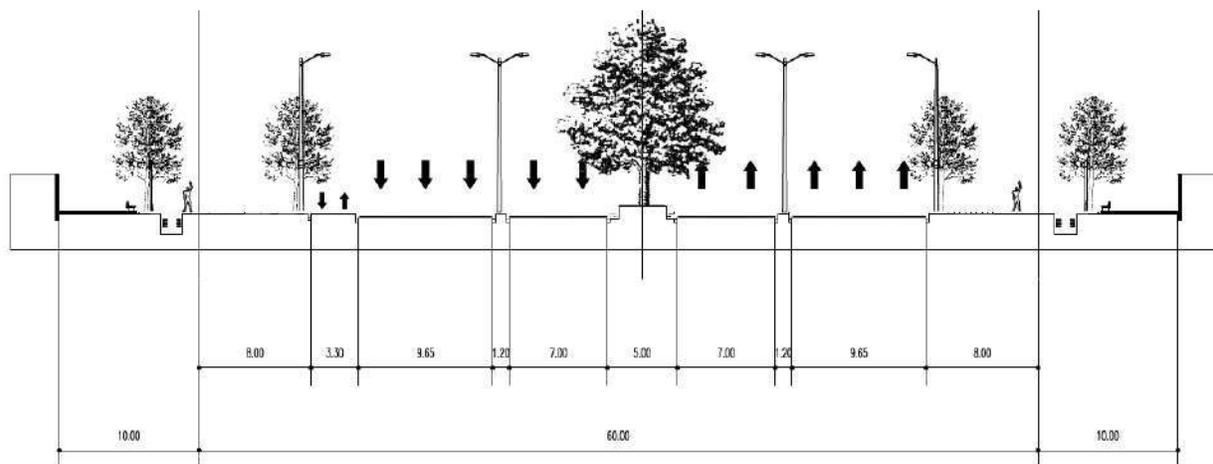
Perfil vial Avenida Medellín (Calle 80)
